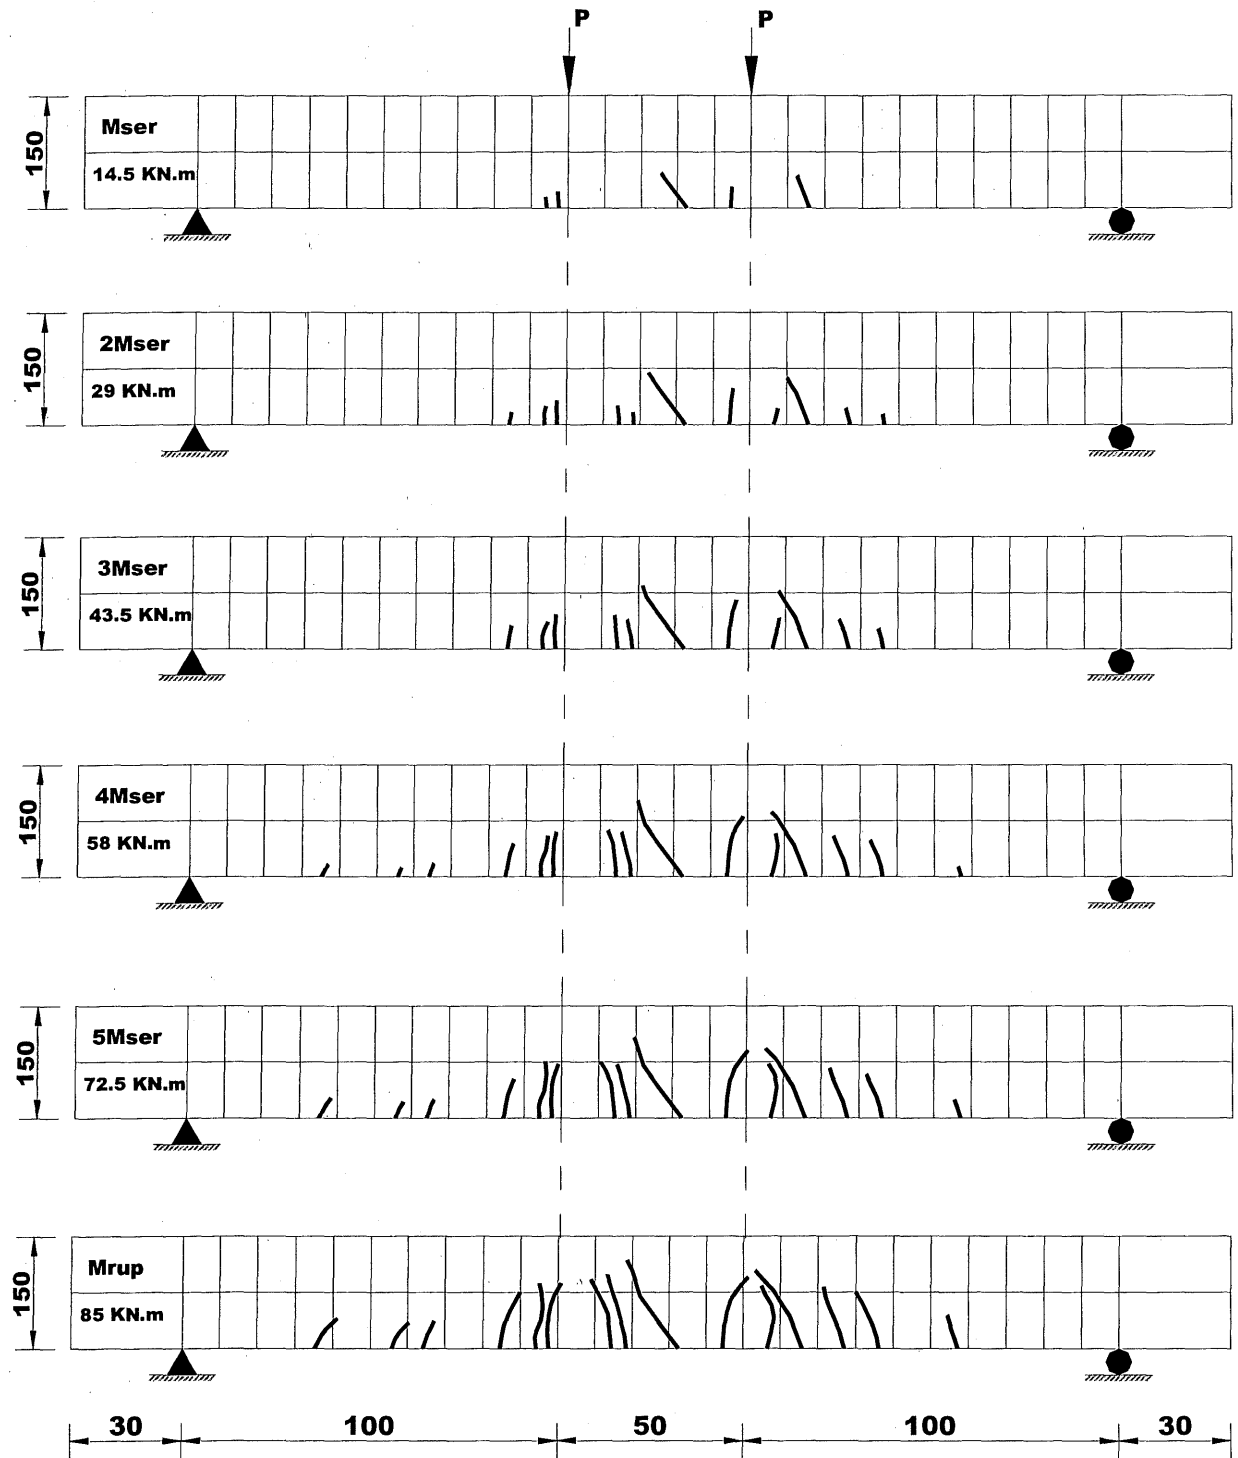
Propagation des fissures au niveau dalle S-CCL
